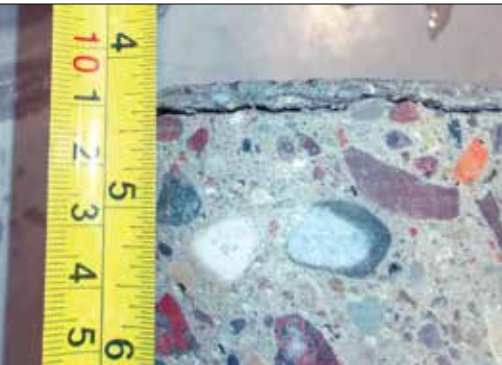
| Powierzchniowa struktura betonu zdegradowana korozją kwasową
